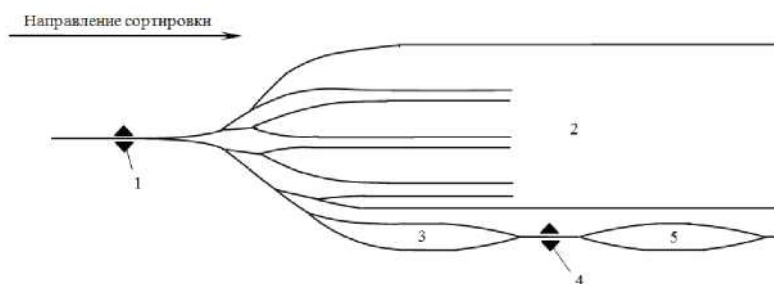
Схема сортировочного парка станции с горкой и полугоркой
